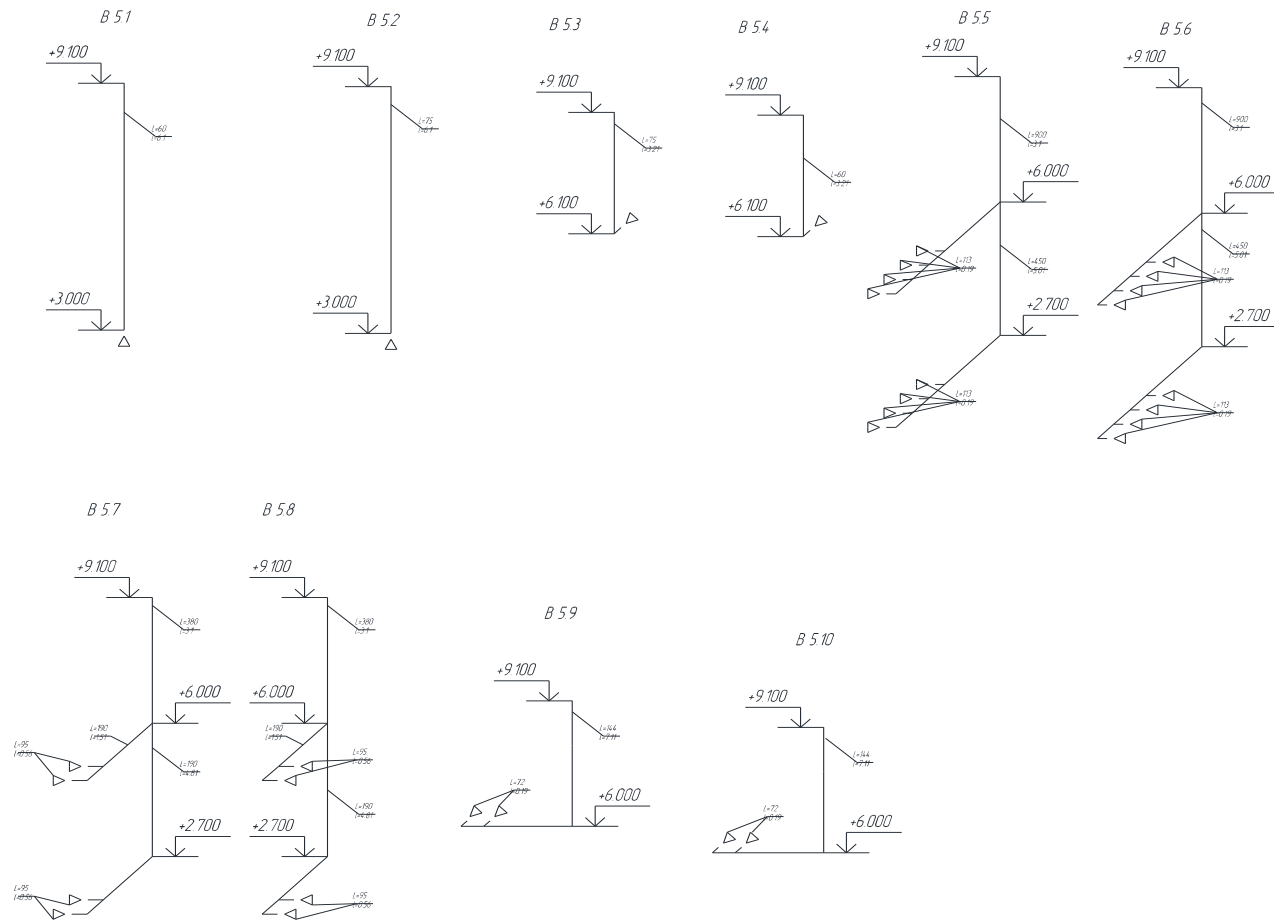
Расчетные схемы систем вентиляции блока №5
